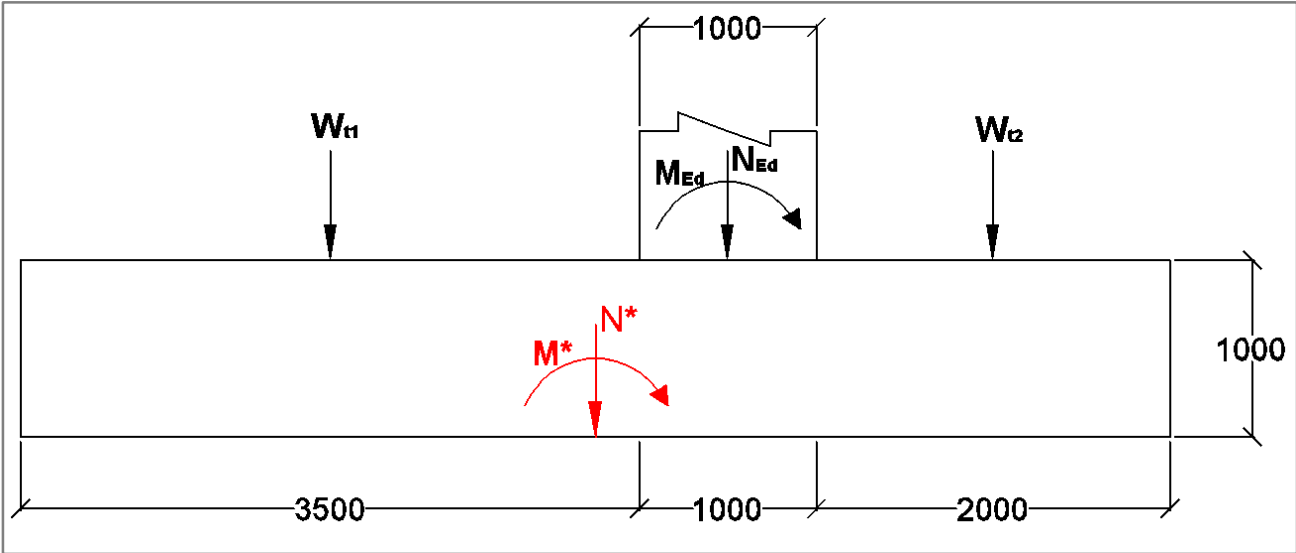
Reducción de esfuerzos al plano de cimentación en el estribo Norte
